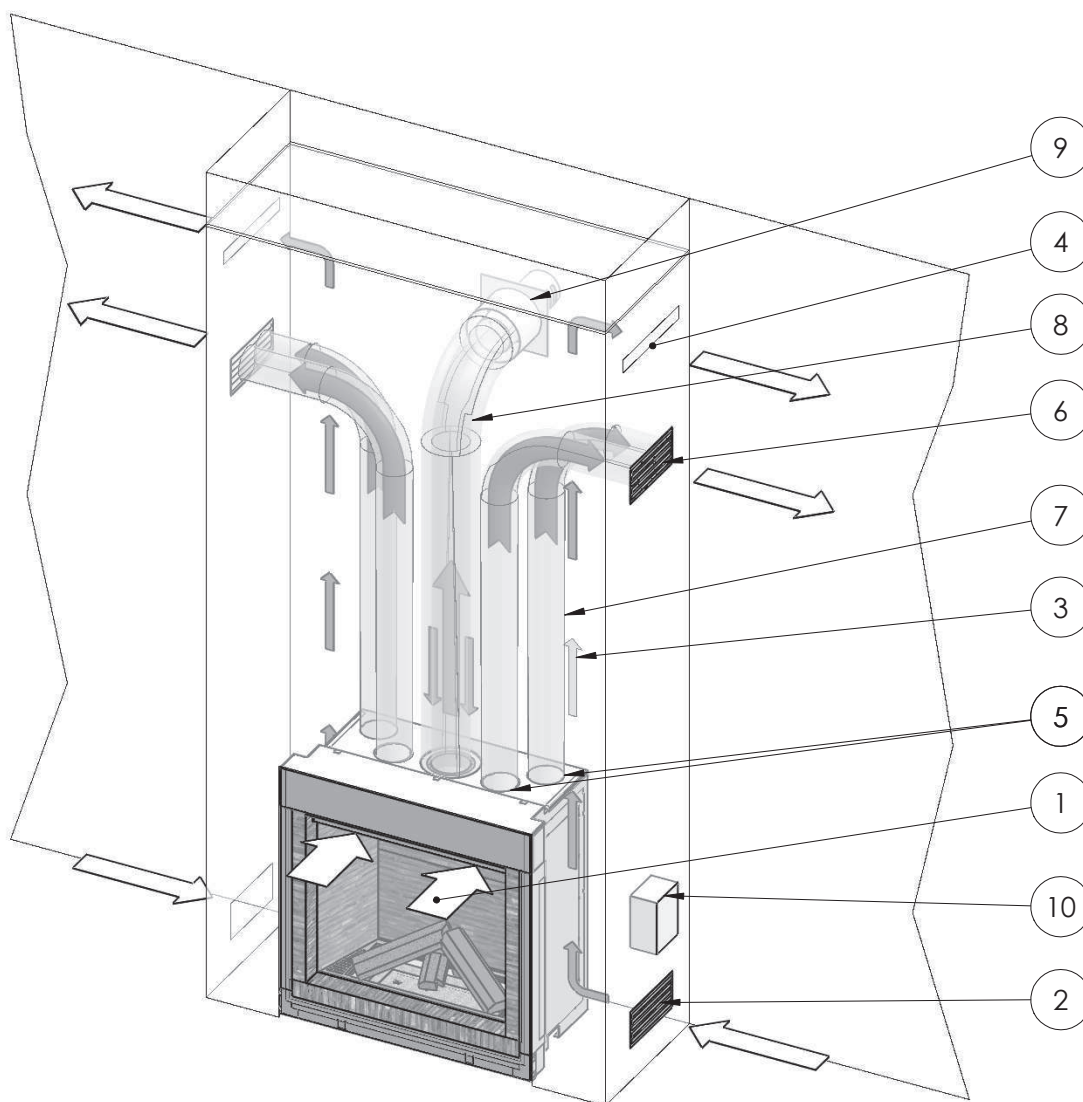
Aparato instalado dentro de una chimenea ventilada
